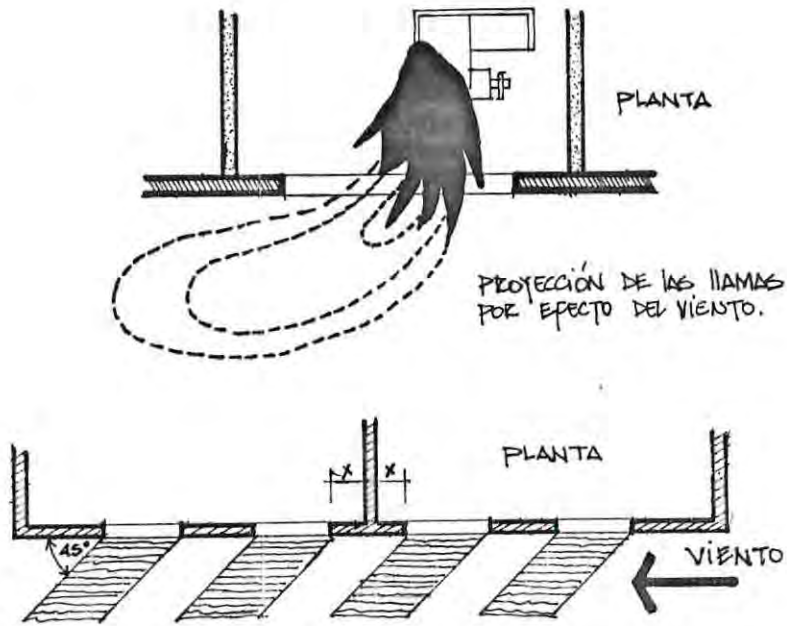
Proyección en planta de las llamas y el calor por efecto del viento.
